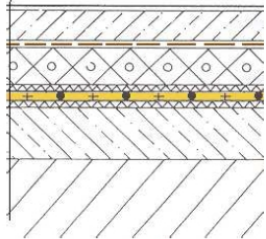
Příklad etapového spoje, kdy je hydroizolace prováděna na nosnou konstrukci z vnější strany
